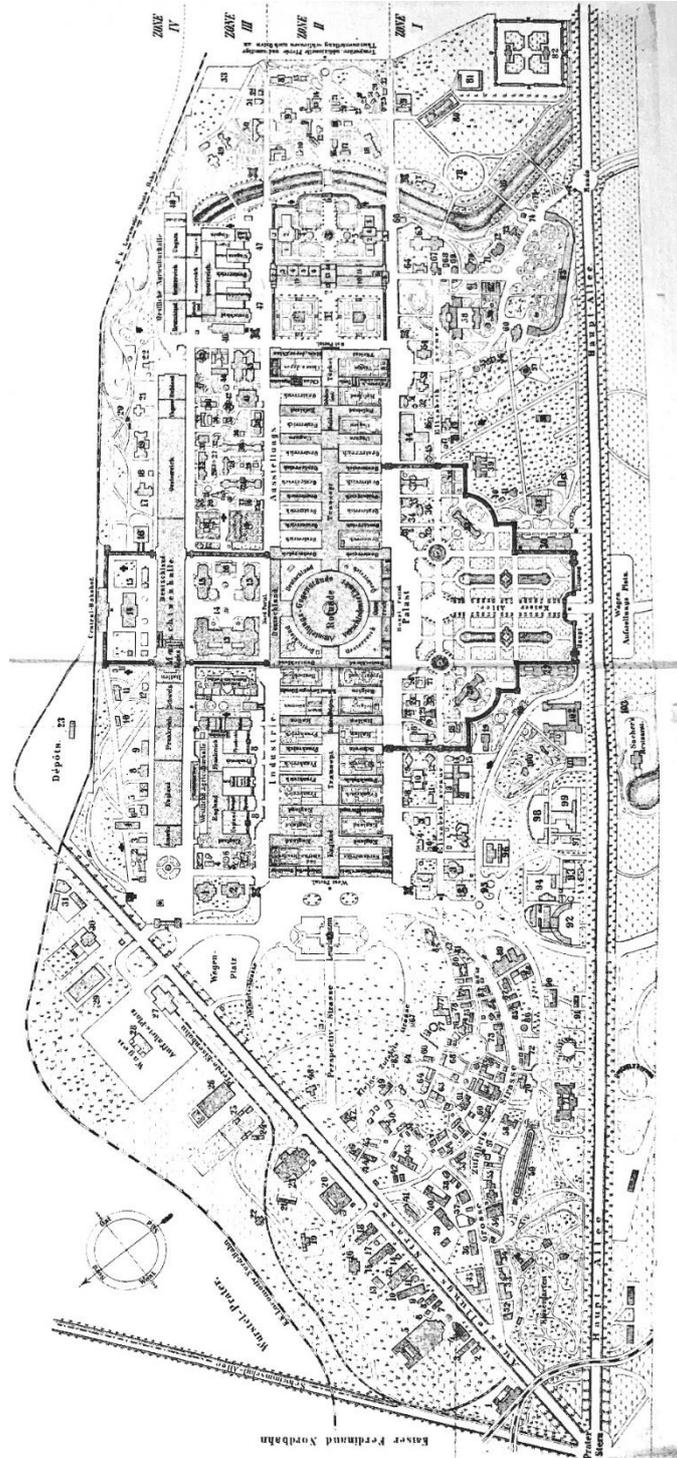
Übersichtsplan der Wiener Weltausstellung 1873, Lageplan, Wien, 1873
